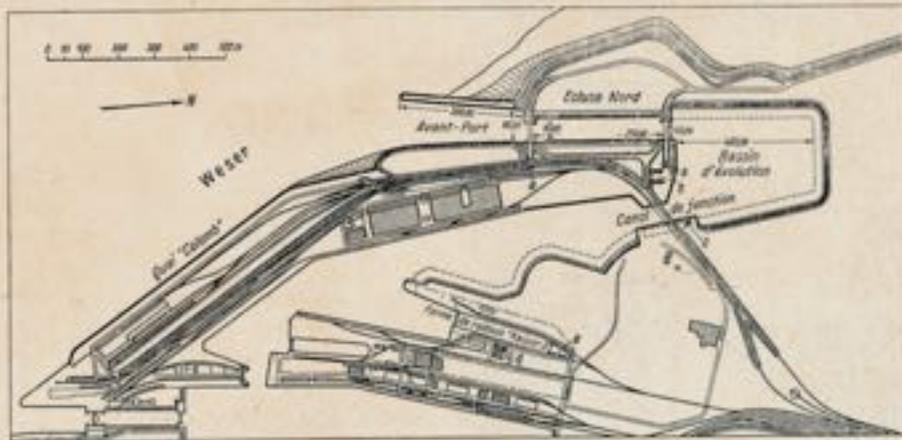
Plan de situation des nouvelles installations maritimes à Bremerhaven.
